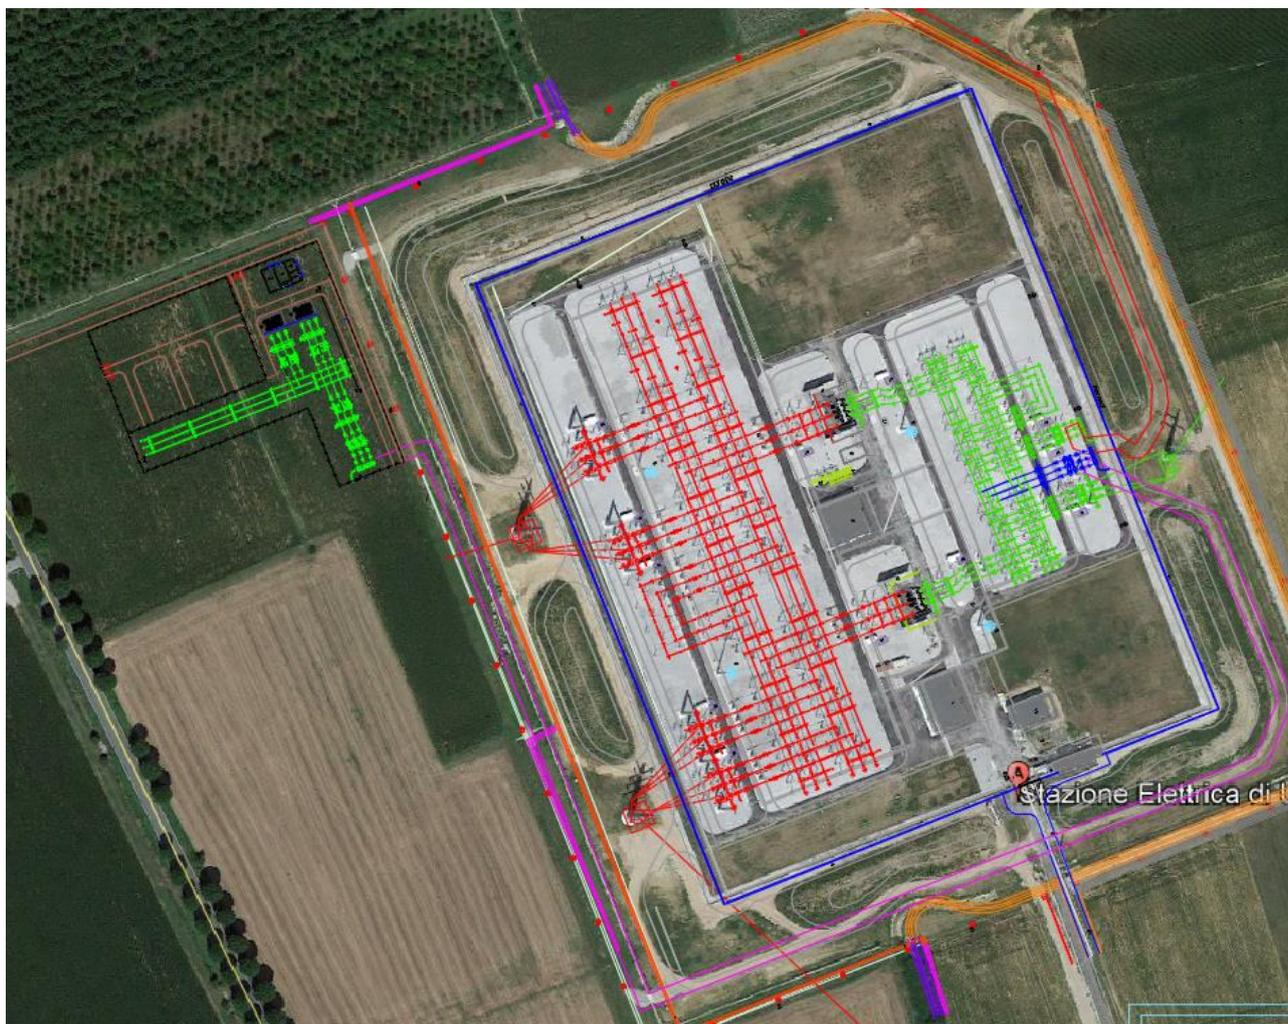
Layout dei collegamenti in cavo verso Stazione TERNA
